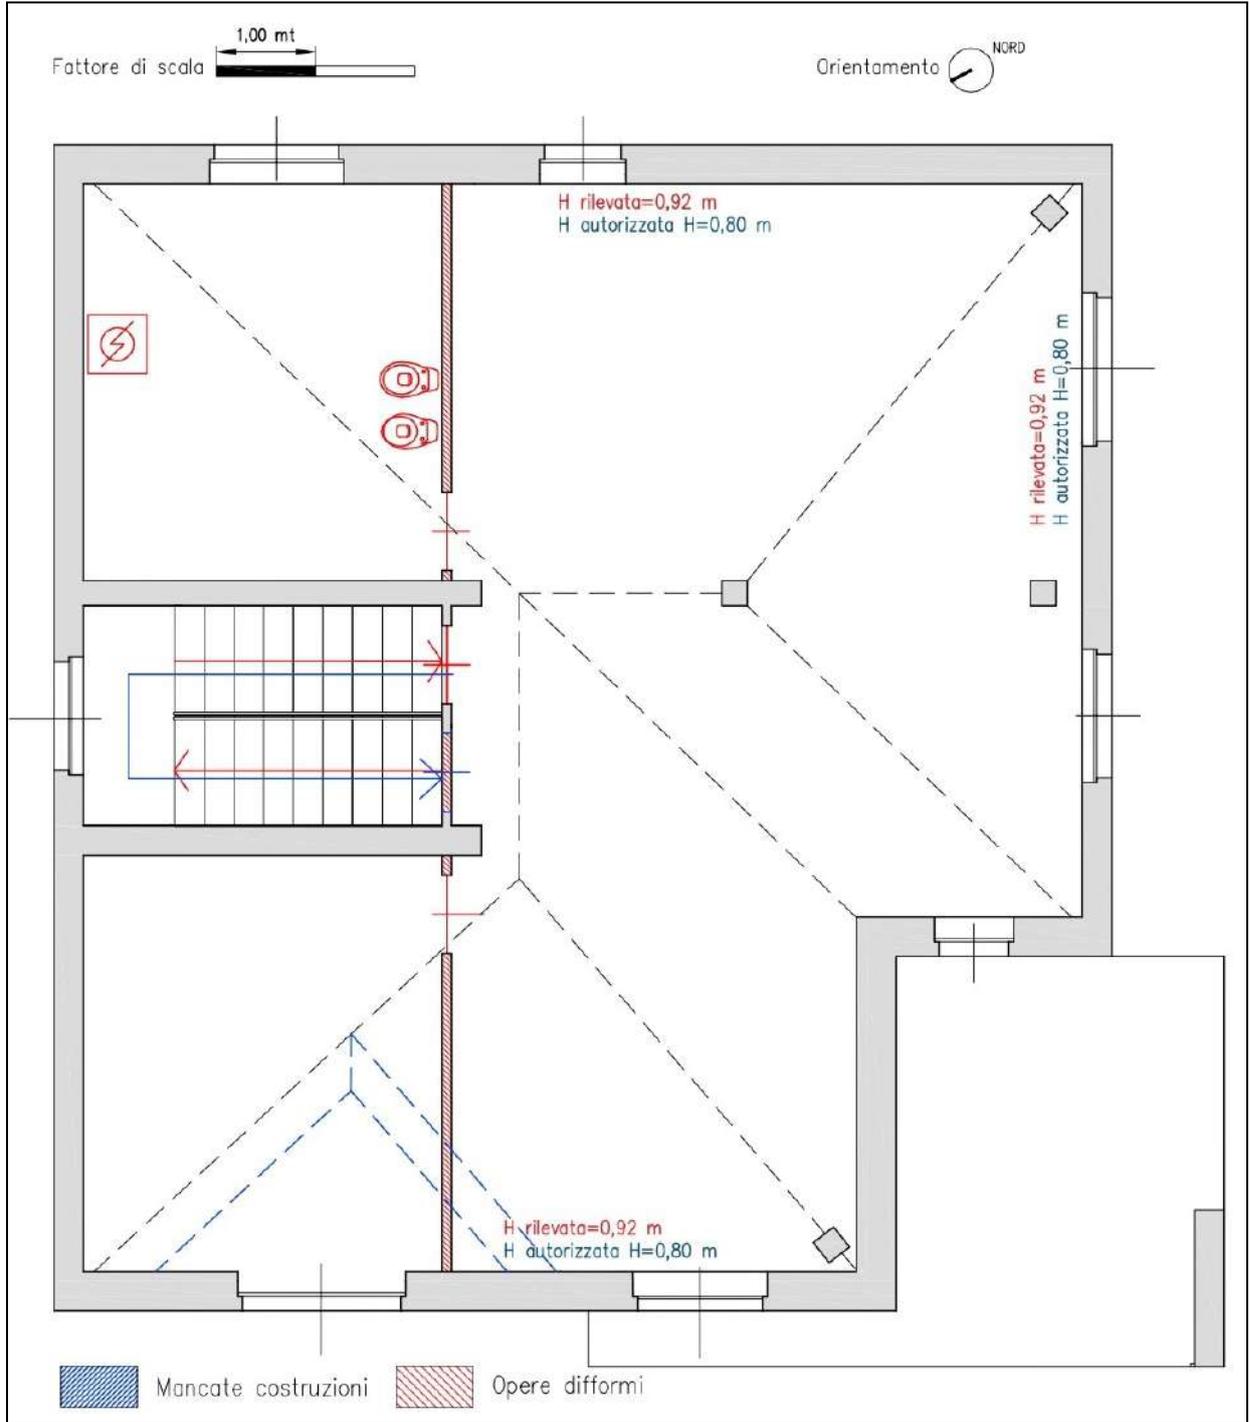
Pianta piano sottotetto - confronto con Licenza di Costruzione n. 1289 del 04.03.1968
